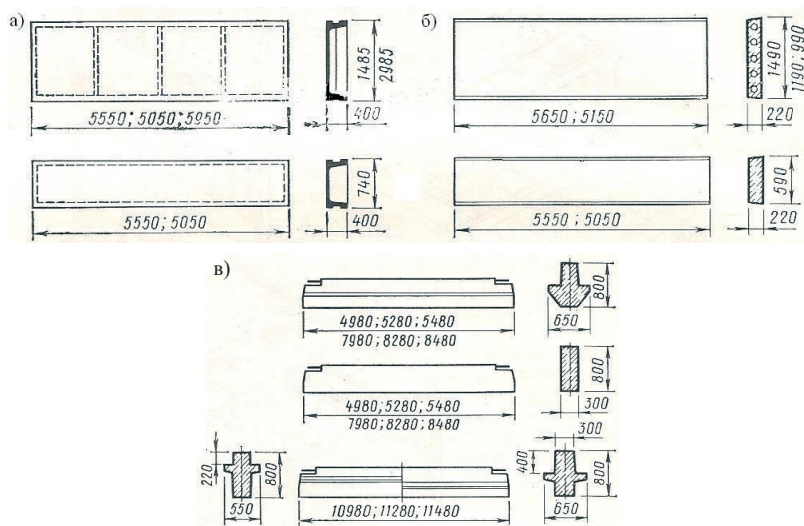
Плиты (а, б) и ригели (в) перекрытий многоэтажных производственных зданий
